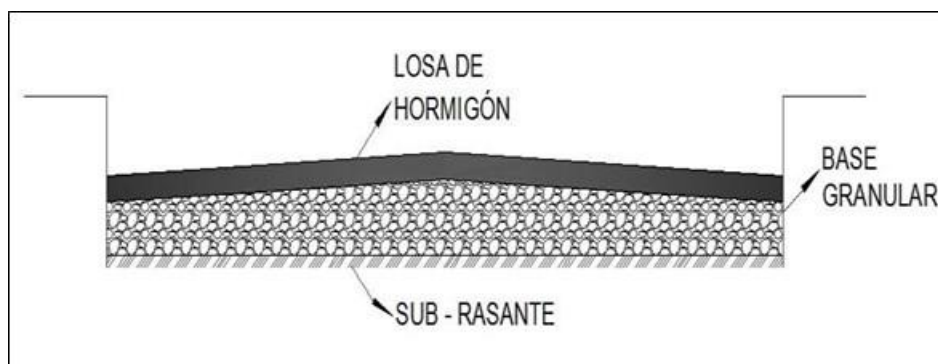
Estructura del Pavimento Rígido - (Salazar Rodríguez, 2018)
